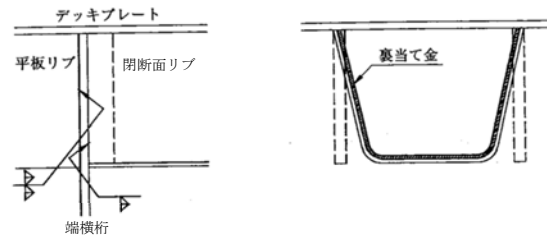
閉断面リブと端横リブ又は端横桁の交差部構造の標準
